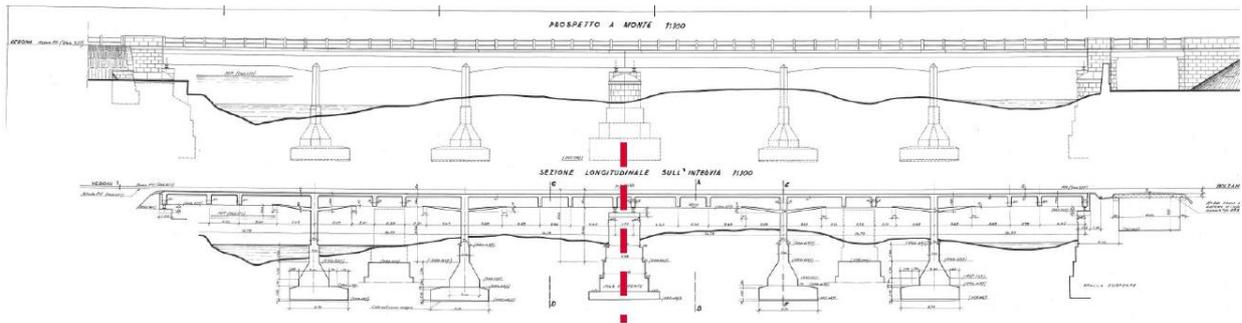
Prospetto e sezione longitudinale Ponte sull'Isarco
